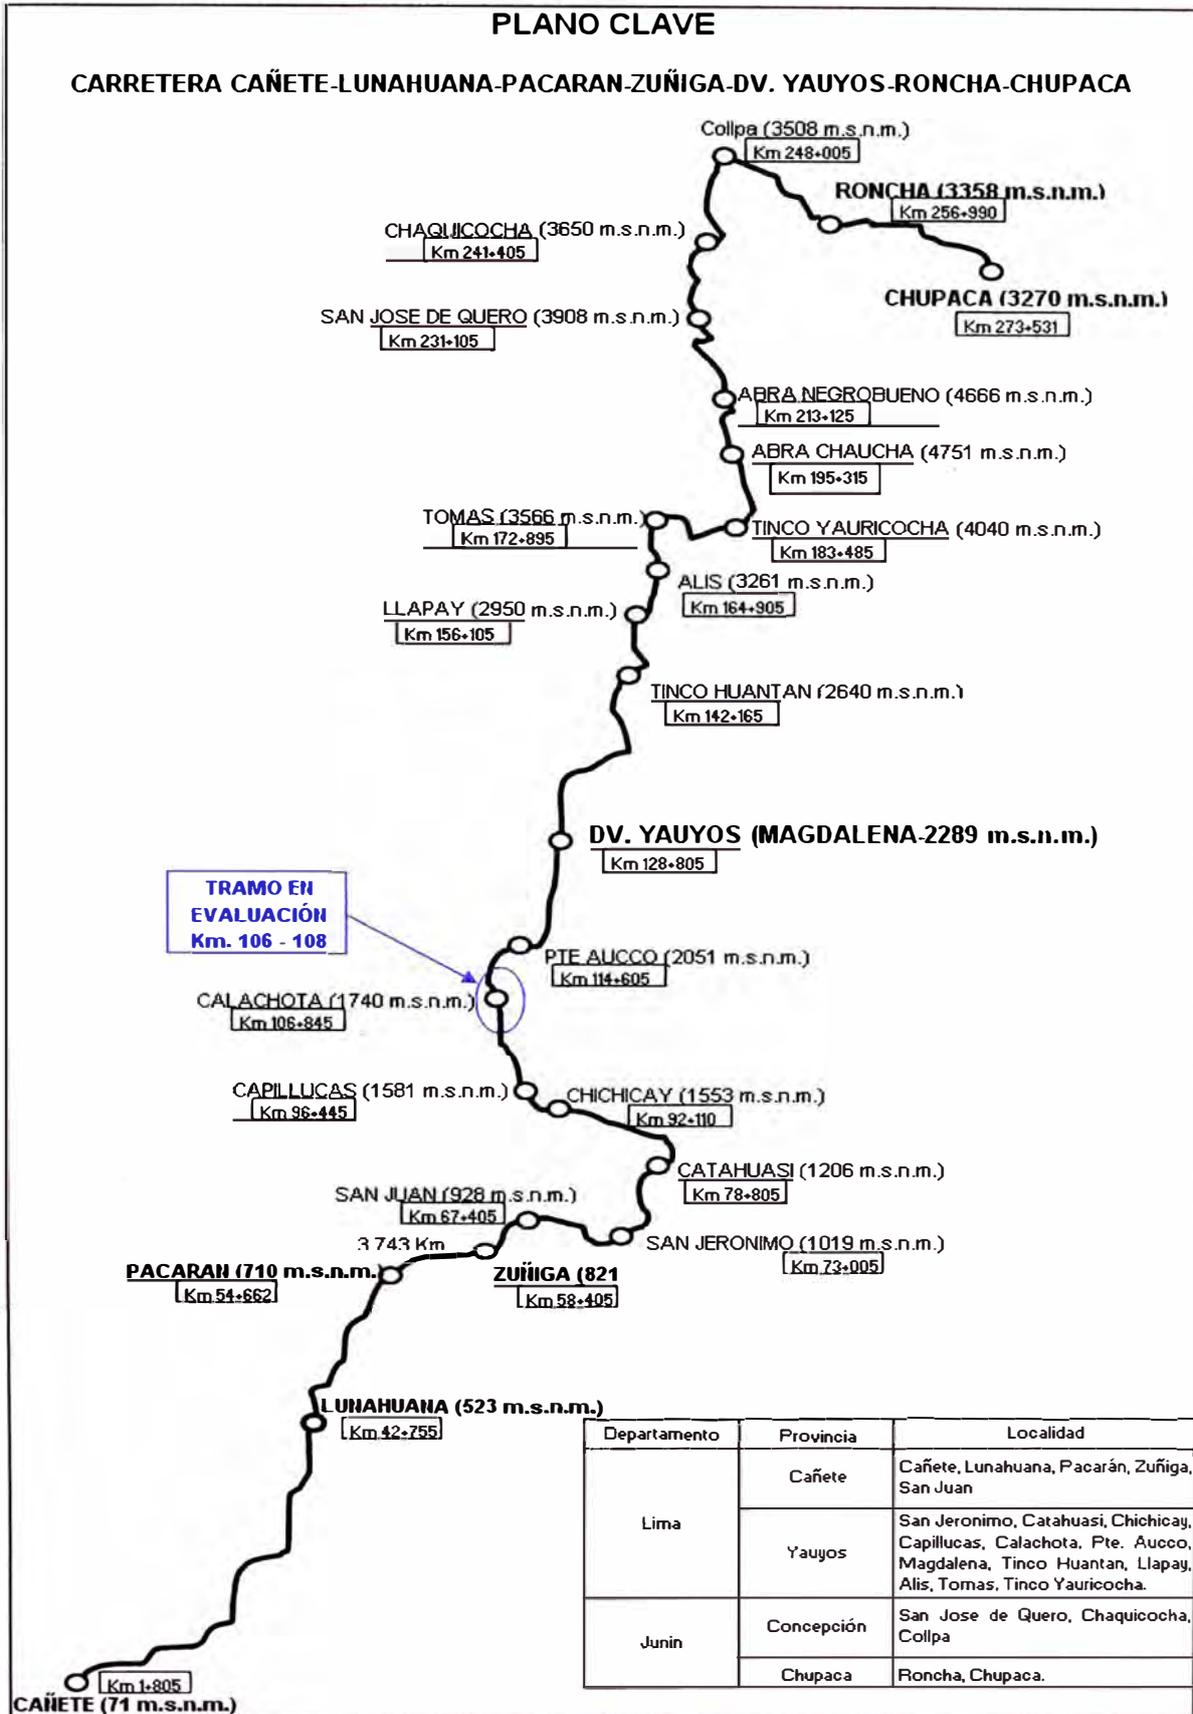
Plano Clave de la carretera Cañete – Yauyos – Chupaca con tramo en Evaluación
